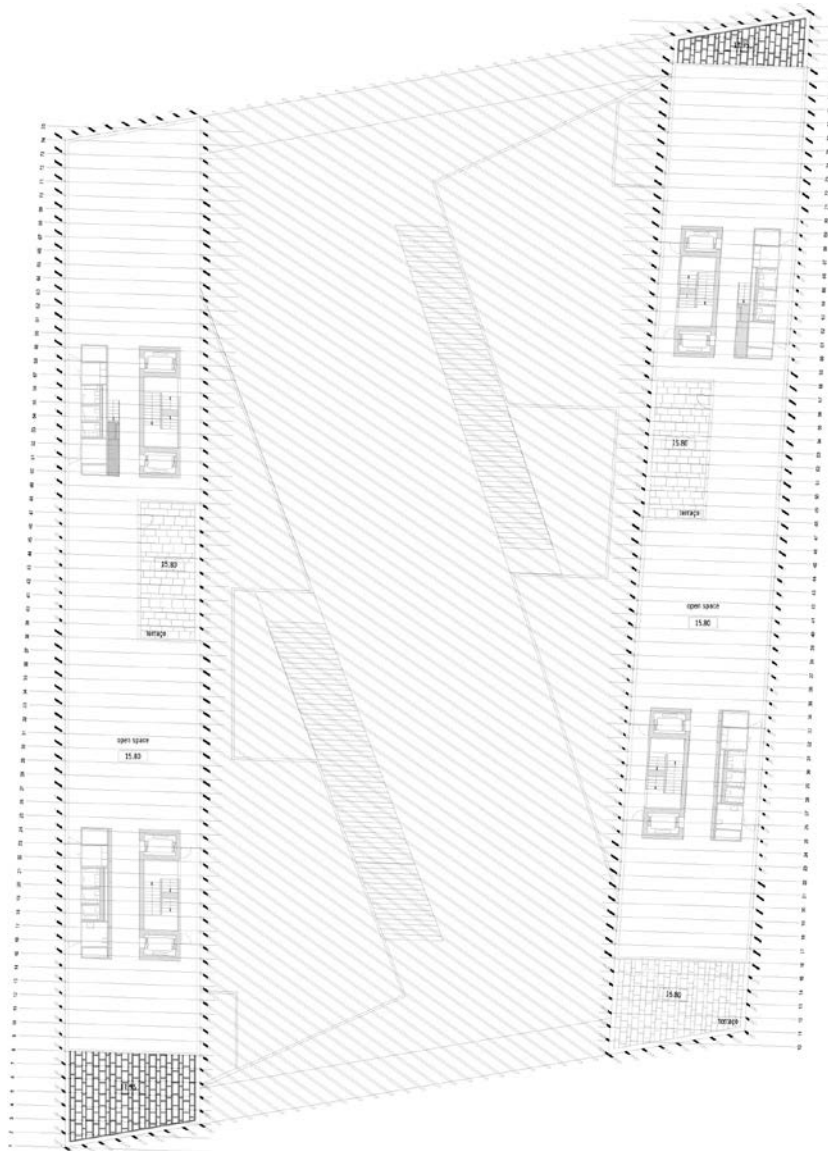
Planta do edifício, Volumes e Praça Central, Aires Mateus, 2012
